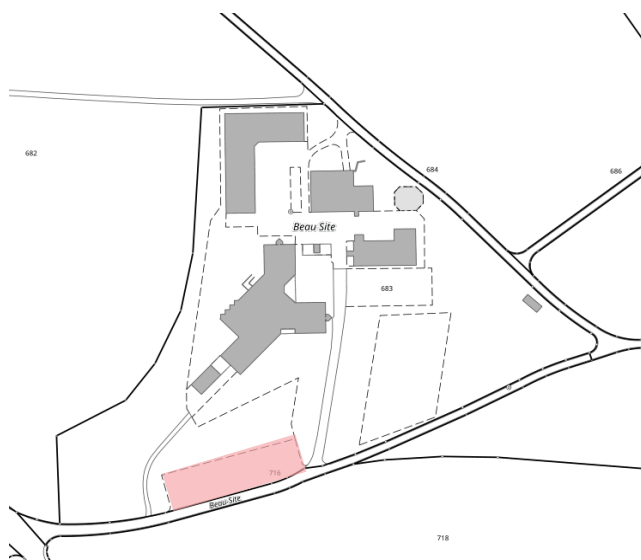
Situationsplan Beau Site in Loveresse (rot: Erweiterungsgebäude)
